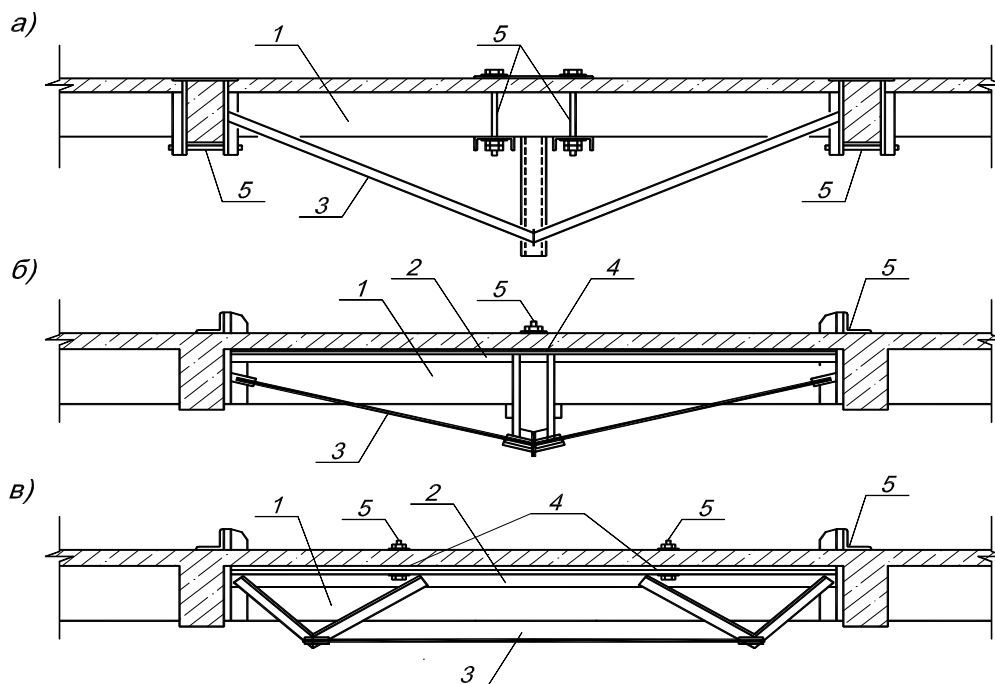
Конструктивные схемы для усиления железобетонных балок
